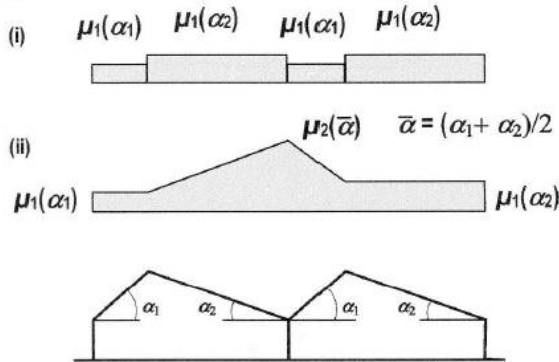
Współczynniki kształtu dachu – dachy dwupołaciowe
